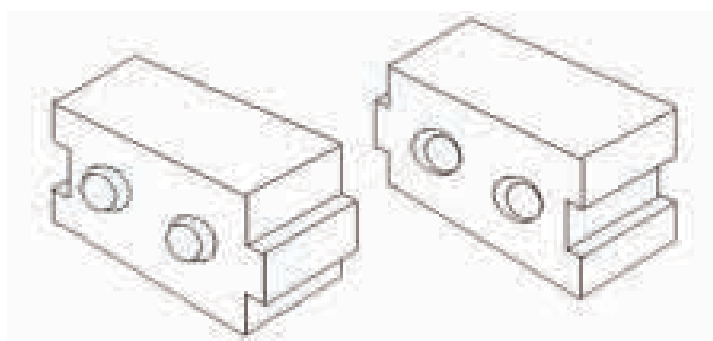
Blocos de Terra Comprimida Estabilizados (BTCE). (Auroville Earth Institute, 2020).
